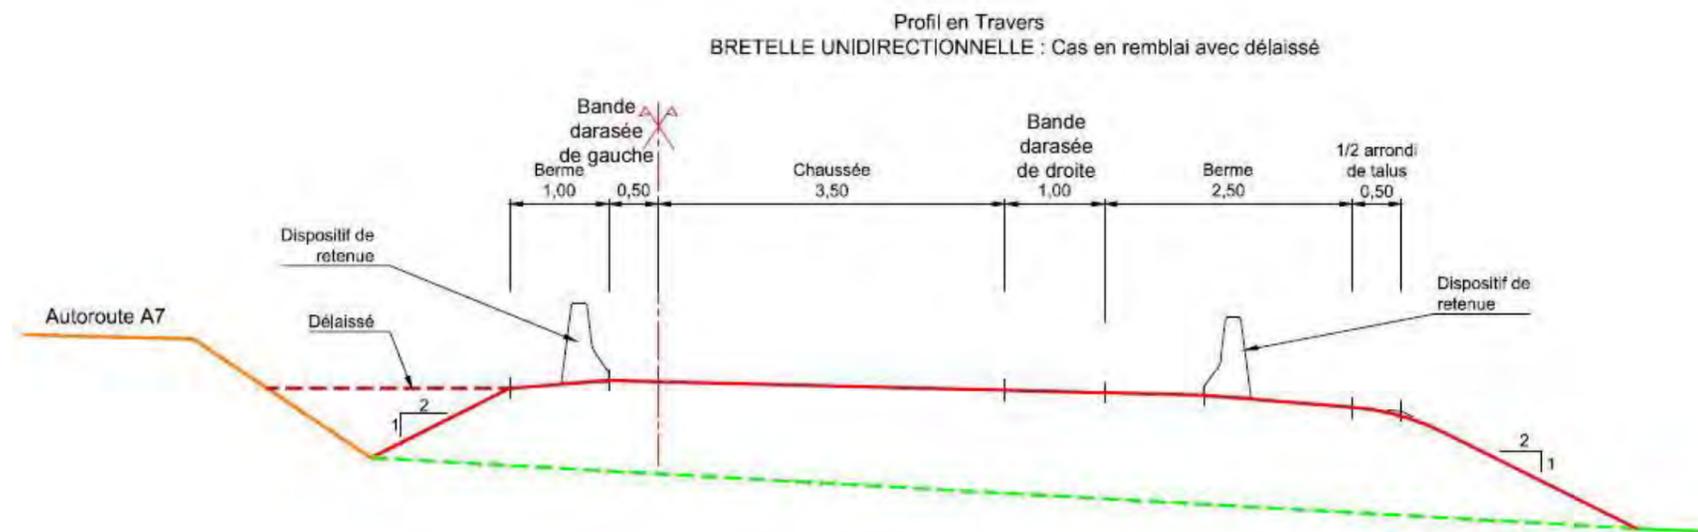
Profil en travers type en bretelle unidirectionnelle : exemple d'un remblai avec délaissé
